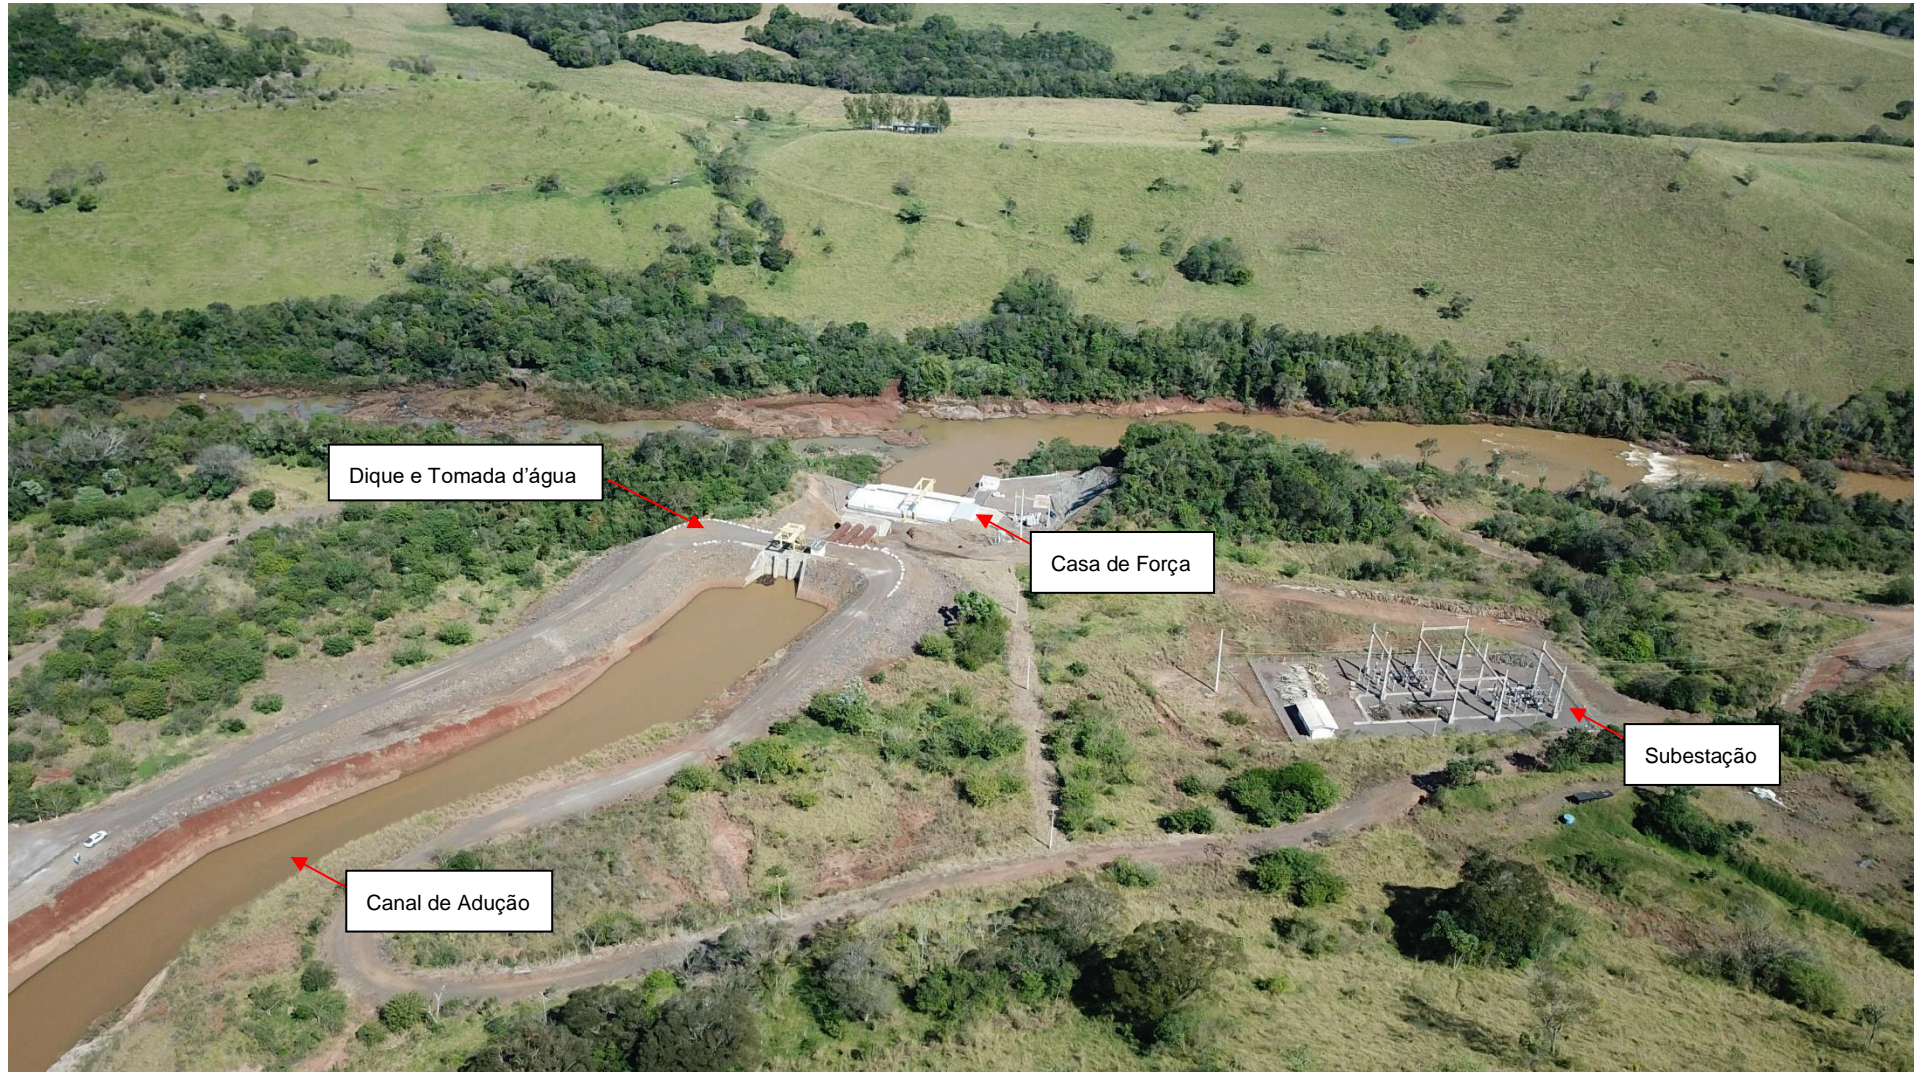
Vista Geral Jusante – PCH Cantú 2
